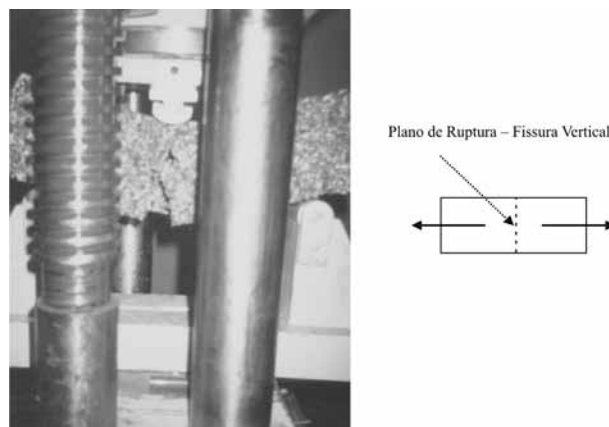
Tipo de Ruptura característica: Fissura vertical devido compressão.
